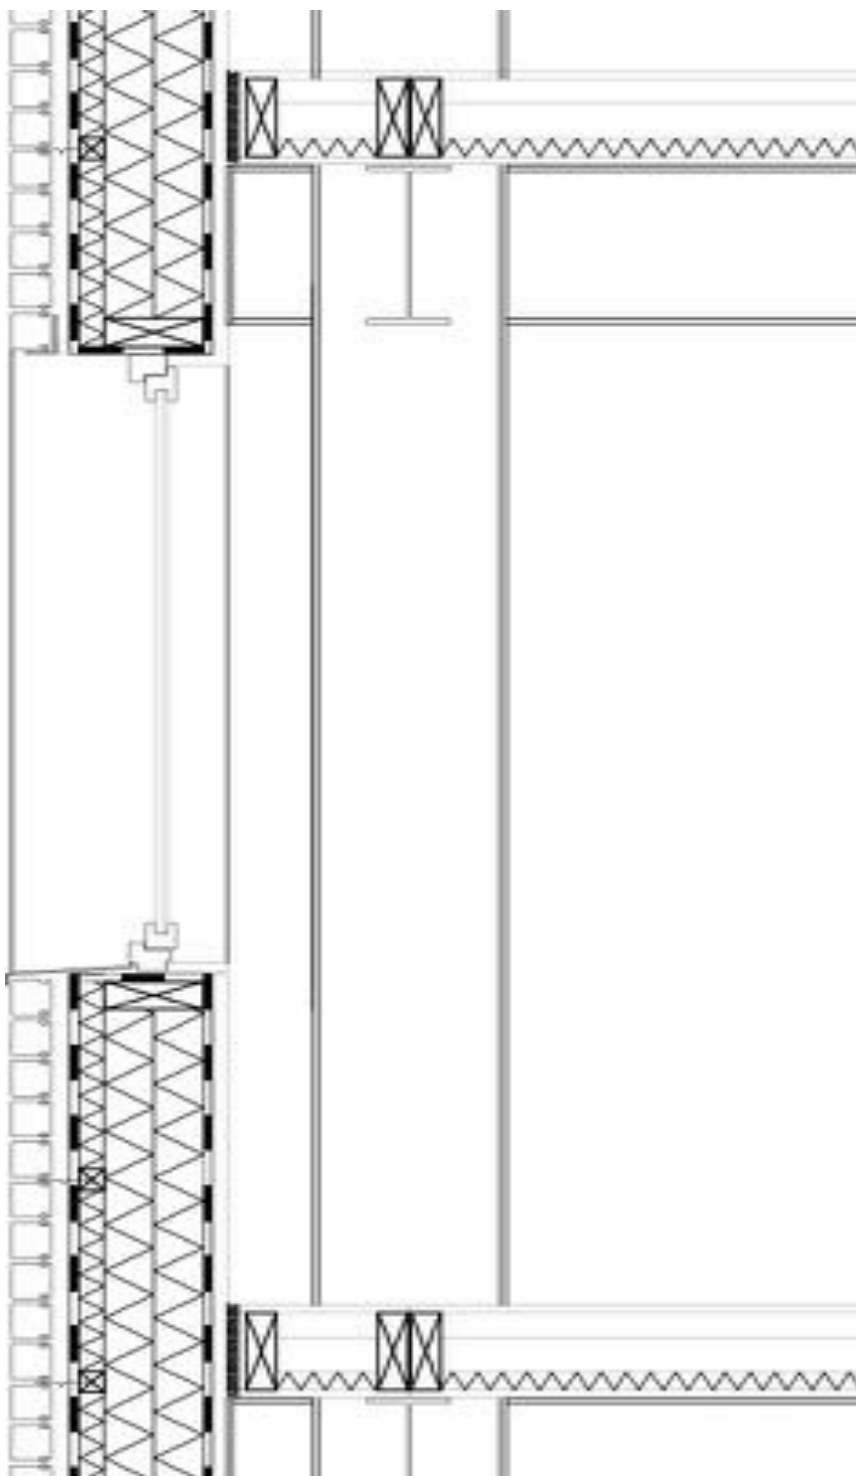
Détail constructif réversible avec parement en briques démontables
